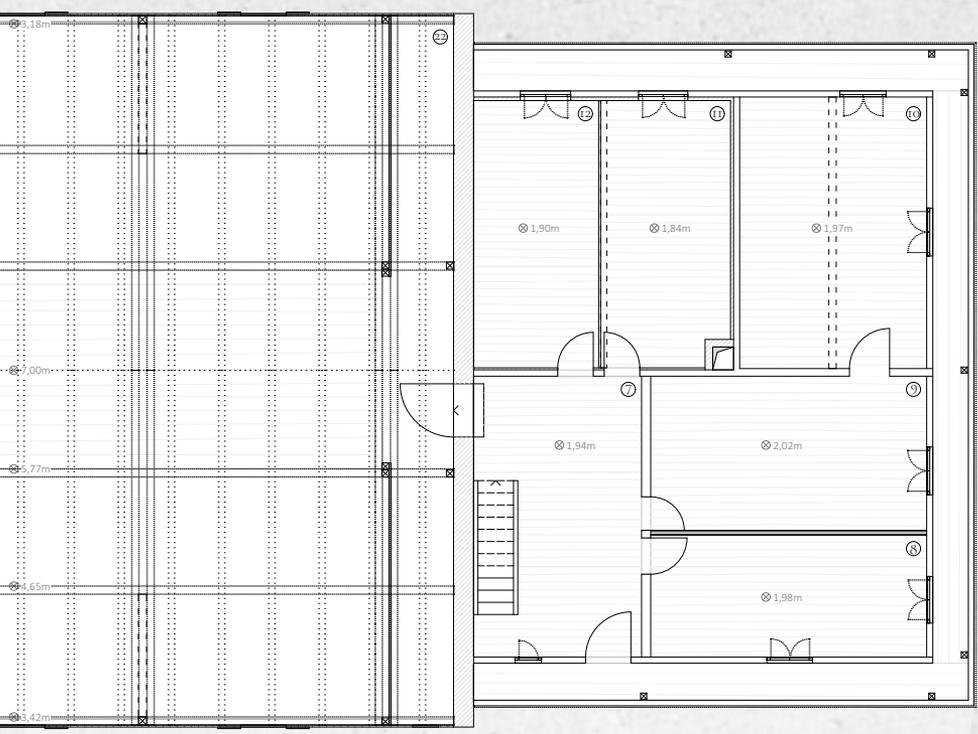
Grundriss Obergeschoss Bestand, 1:150
